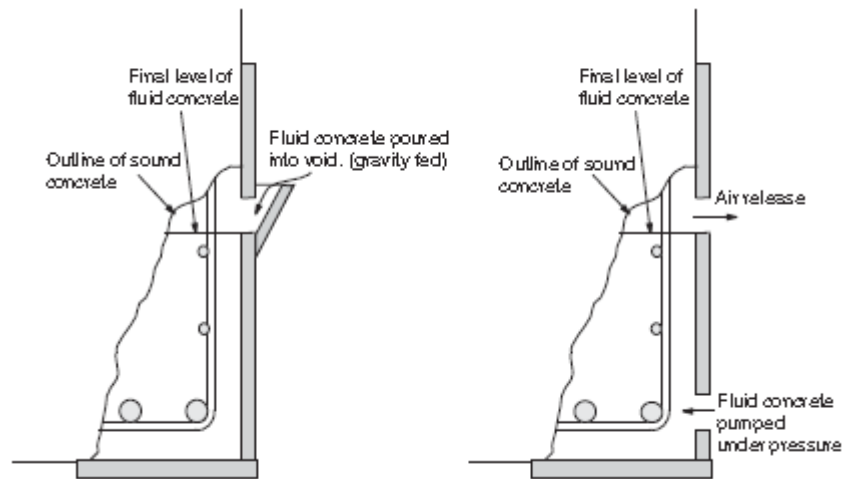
Boîte aux lettres traditionnelle pour l'application de béton fluide sur un élément de poutre.
